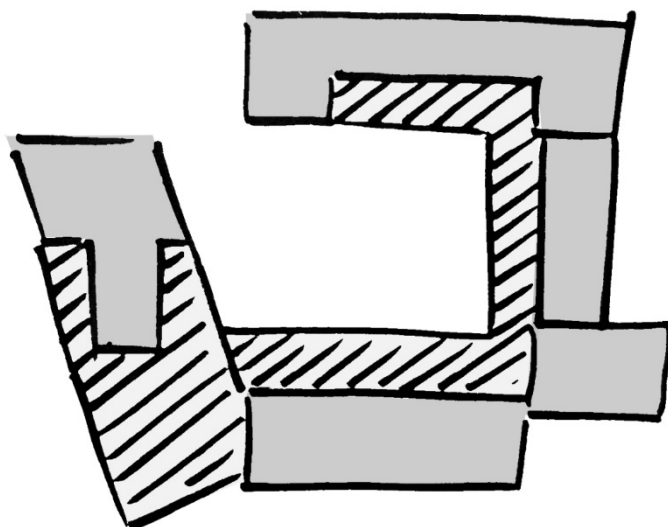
Il nuovo sistema di portici permette una lettura degli spazi tra interno ed esterno nel pieno rispetto delle zone private
